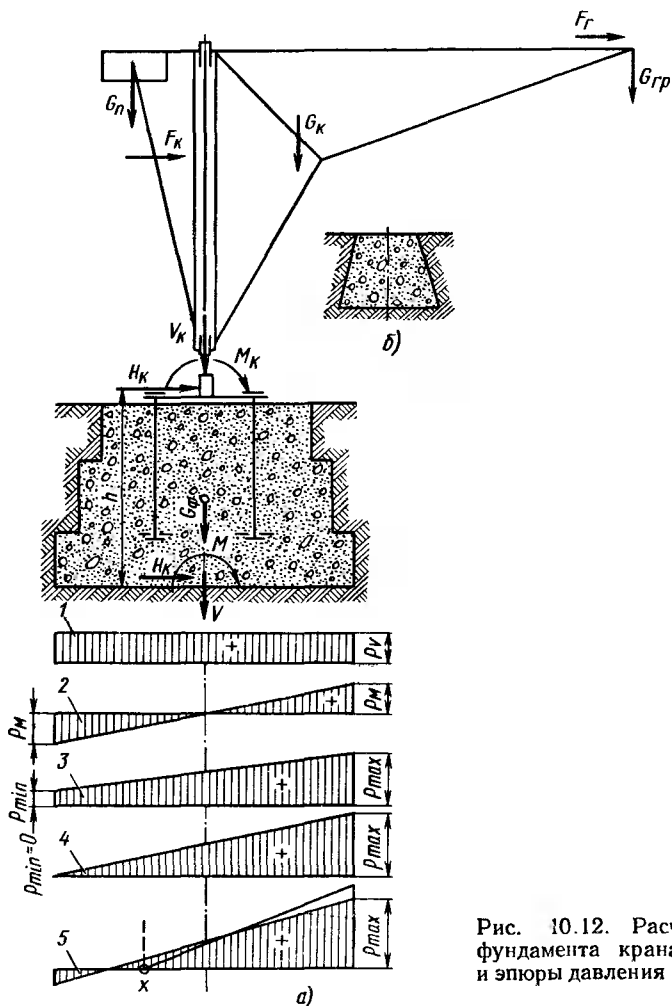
Расчетная схема фундамента крана на колонне и эпюры давления на грунт
